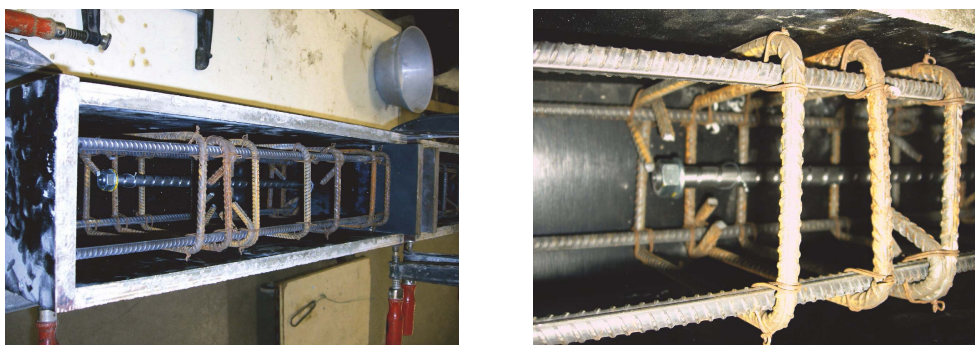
Vista geral da disposição de armaduras e da montagem do provete com o transdutor para betonagem.
